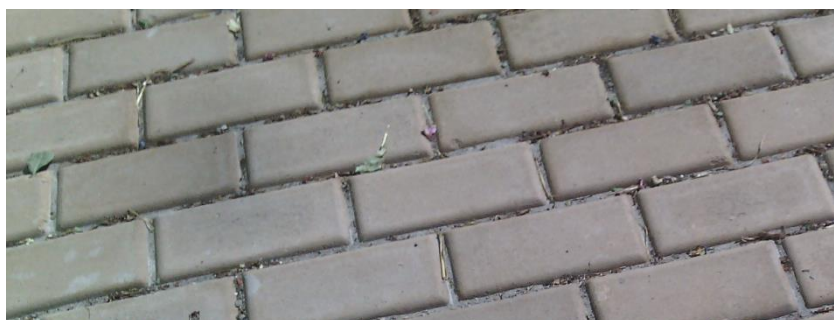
Imagen de los adoquines elegidos para los caminos pavimentados.
